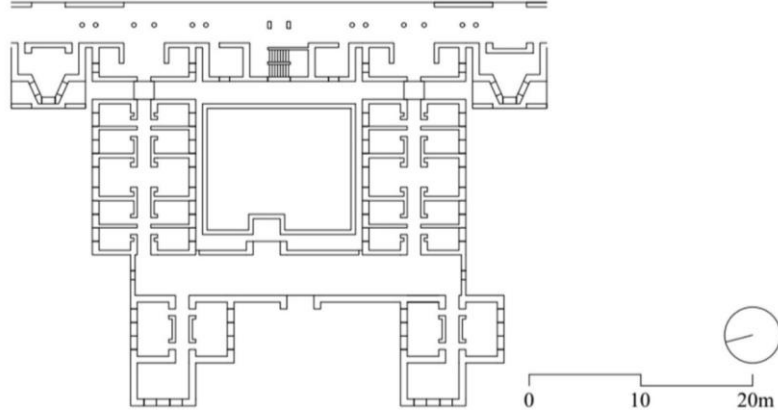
IIM Kompleksi, A Blok (Giriş) Binası, (zemin) kat planı
